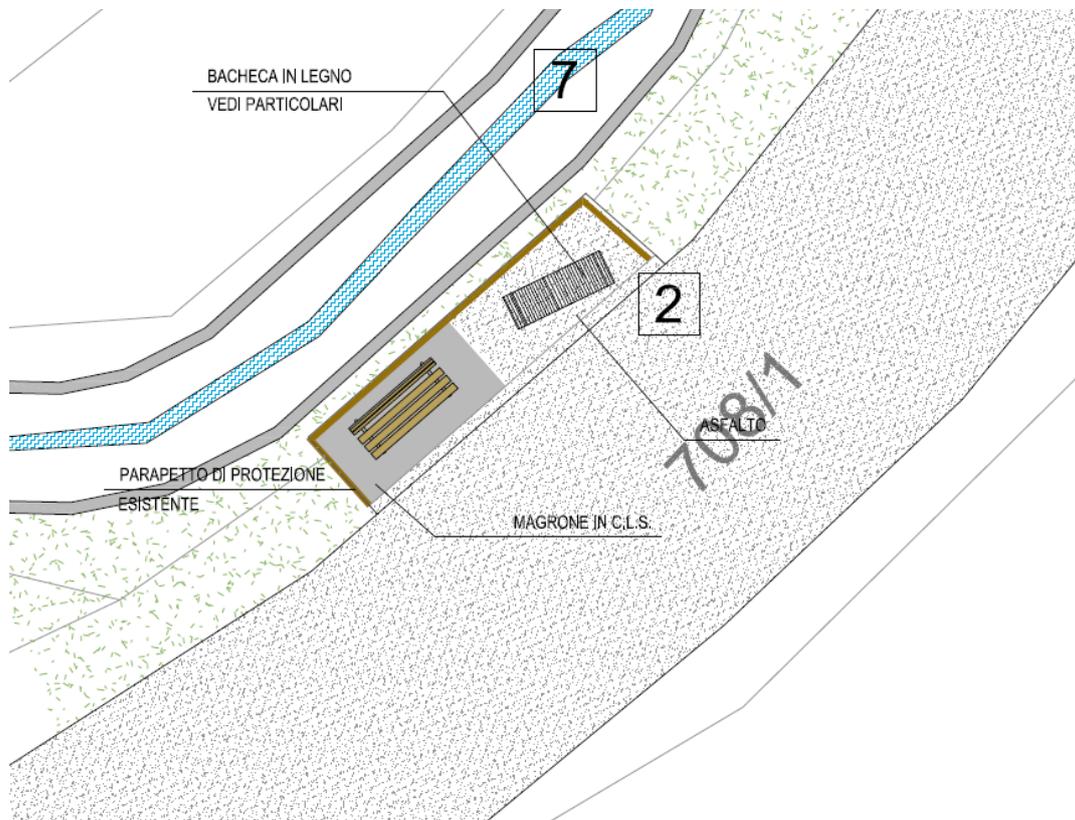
Estratto "Planimetria generale di progetto - intervento 4" scala a vista.
